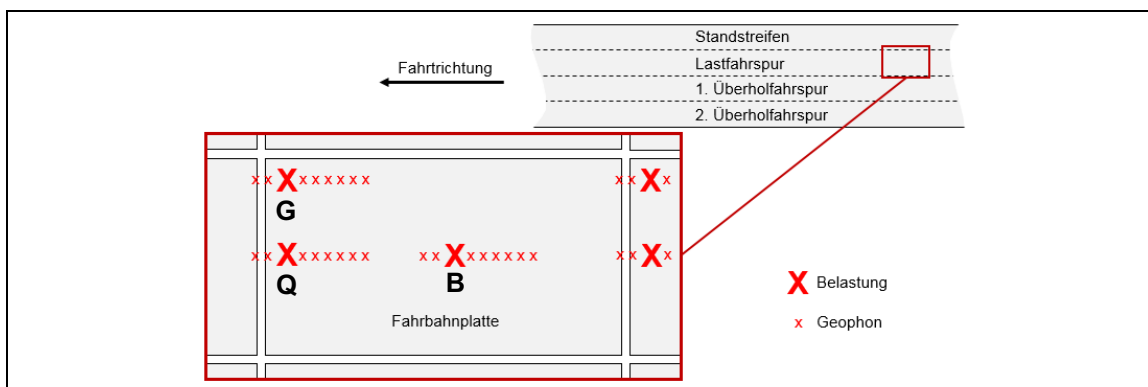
Belastungs- und Messpunkte der durchgeführten FWD-Messungen
